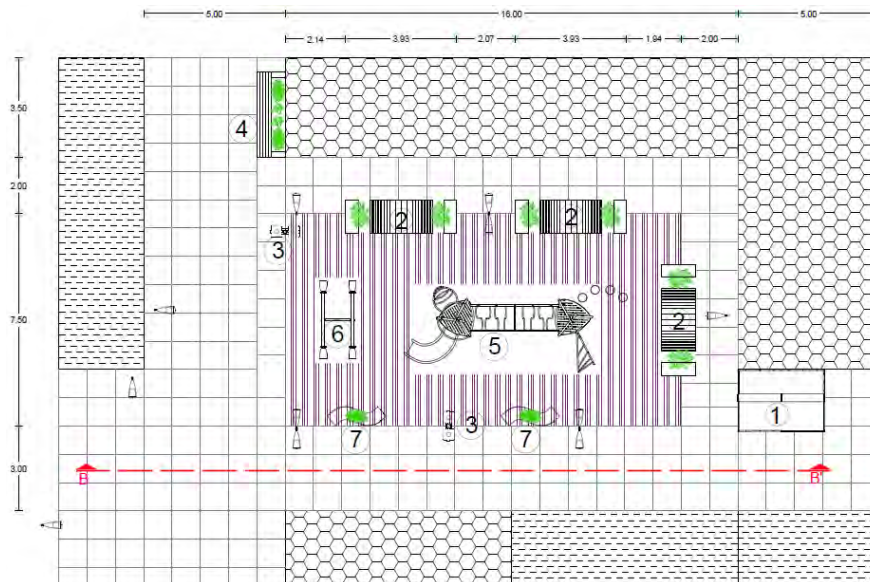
Planta arquitectónica de la plaza 9. Se ve la distribución del mobiliario ocupado y el cambio de piso.
